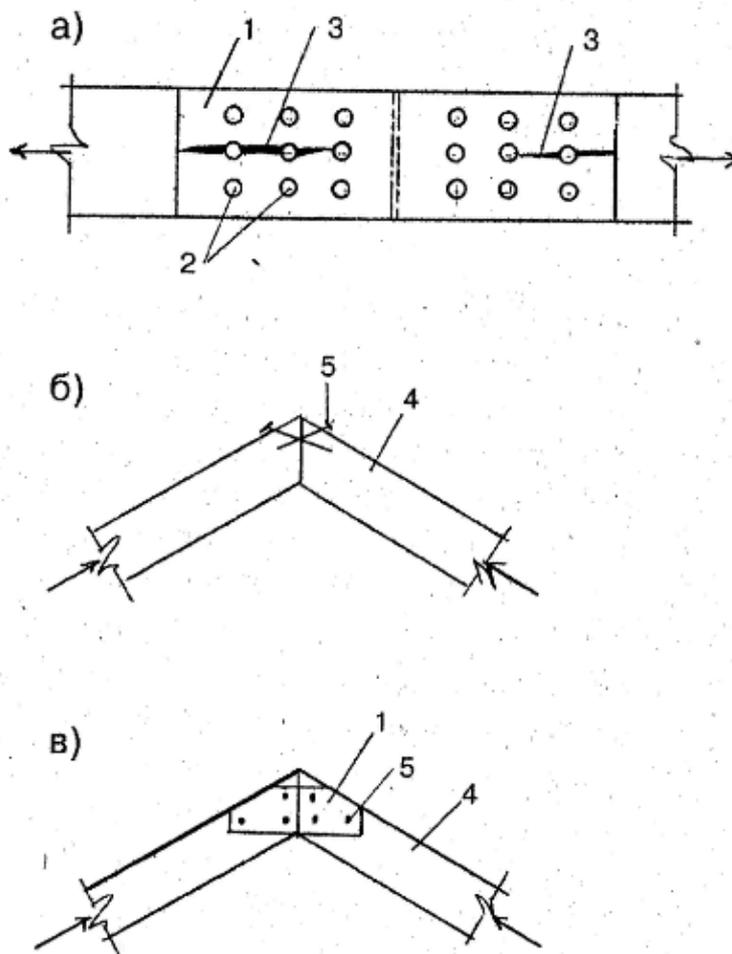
Дефектные узлы соединения деревянных конструкций (а, б – неправильные, в – правильные): 1 – стыковая накладка; 2 – нагели; 3 – трещина; 4 – стропильные ноги; 5 - гвозди
